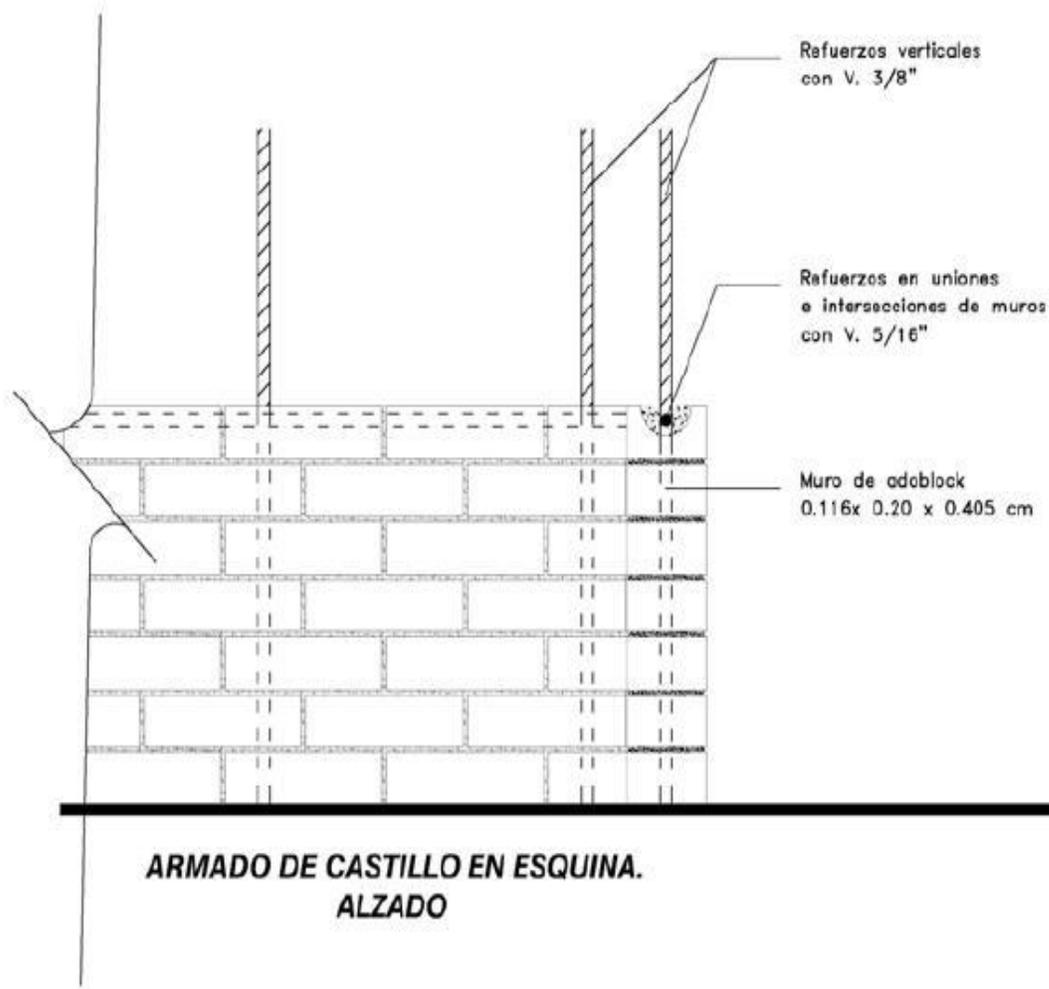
detalle refuerzos verticales y refuerzos en las esquinas.
